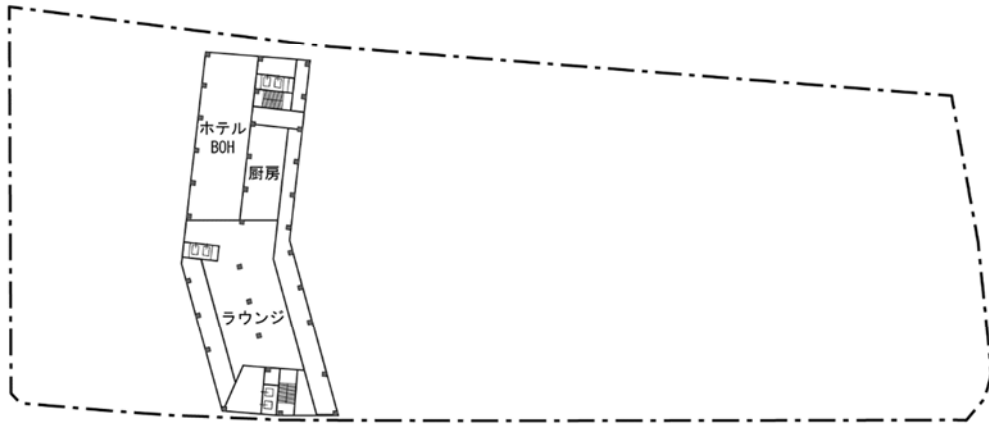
(6) 各階平面図 (アリーナ敷地 : 10階、11～13階)
